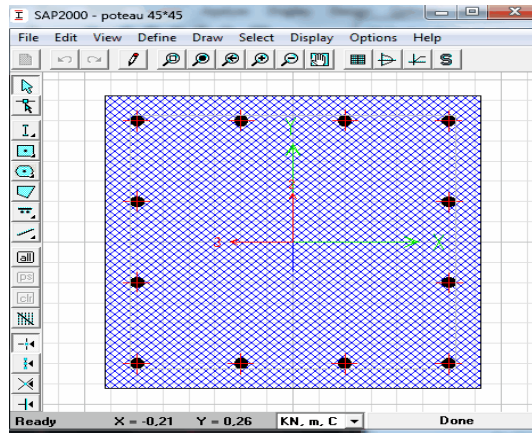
Dessin de ferrailage de poteau (45x45) sur SAP2000.
